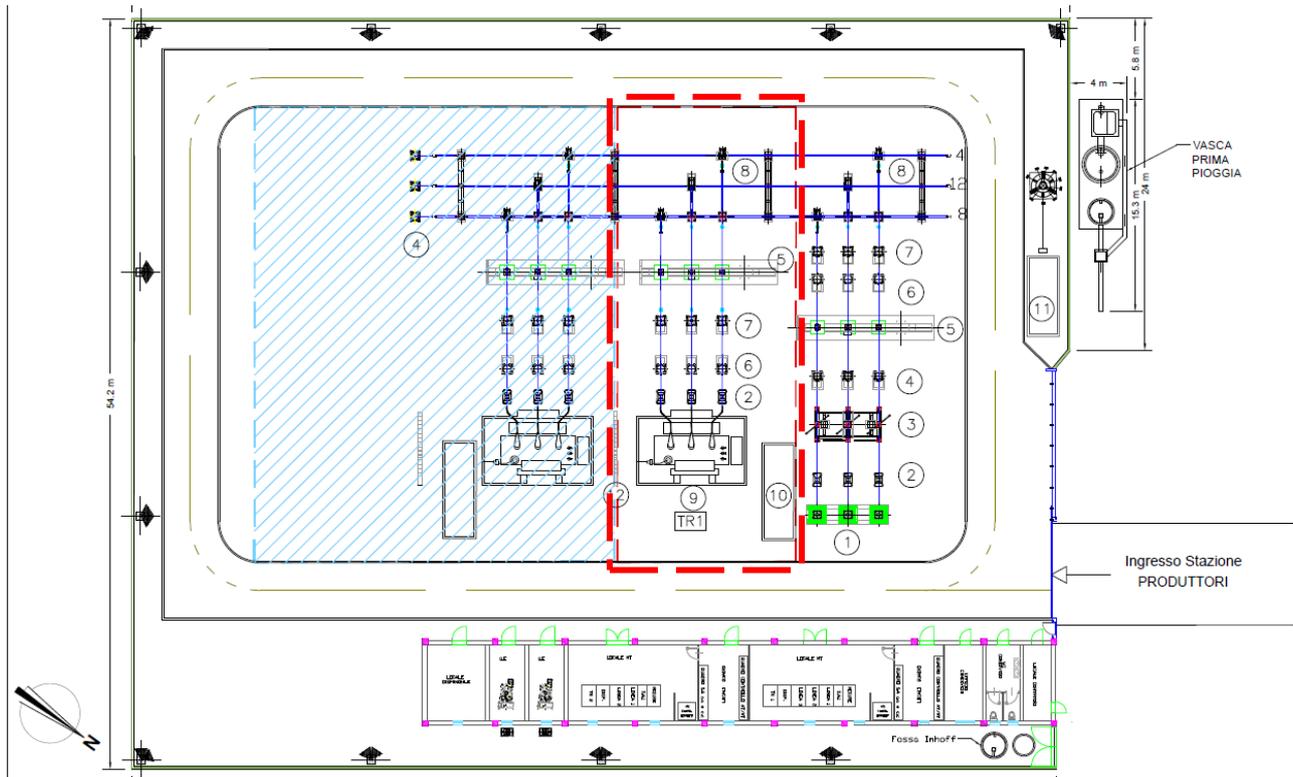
\_layout stazione elettrica - impianto Acea Solar e condominio
